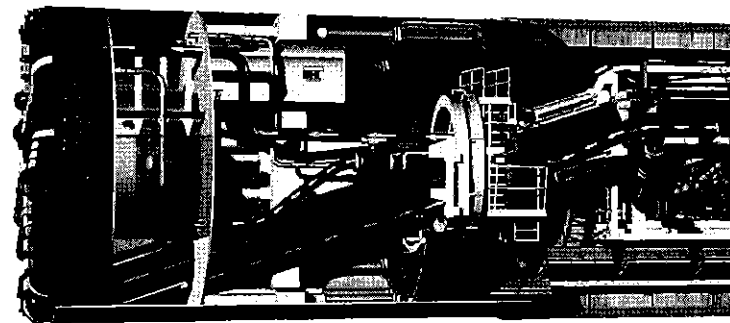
VD-TBM(HERRENKNECHT, Tunnel talk HPより)
